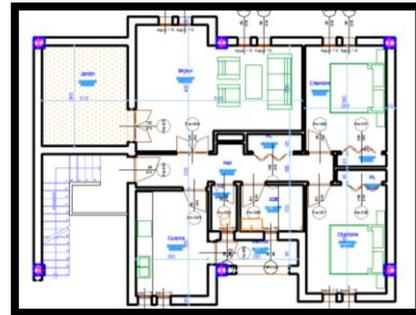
plan de niv2 du semi collectif type B. source : auteurs
